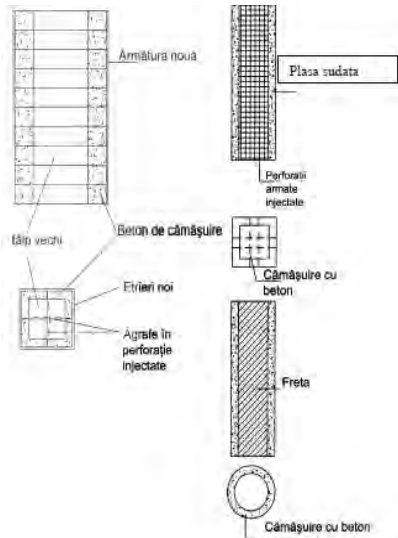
Cămășuirea stâlpilor de zidărie cu beton armat [97]
